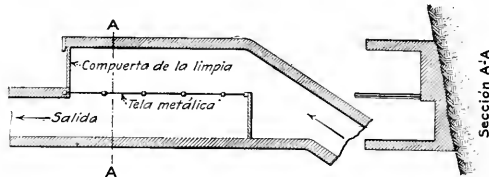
DETALLES DE LA COLADERA AUTOMÁTICA
